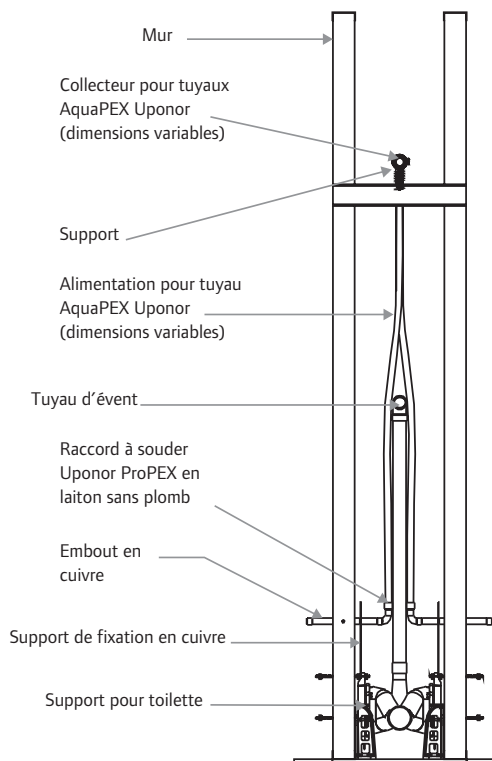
Vue de section d'un ensemble de chasses publiques
